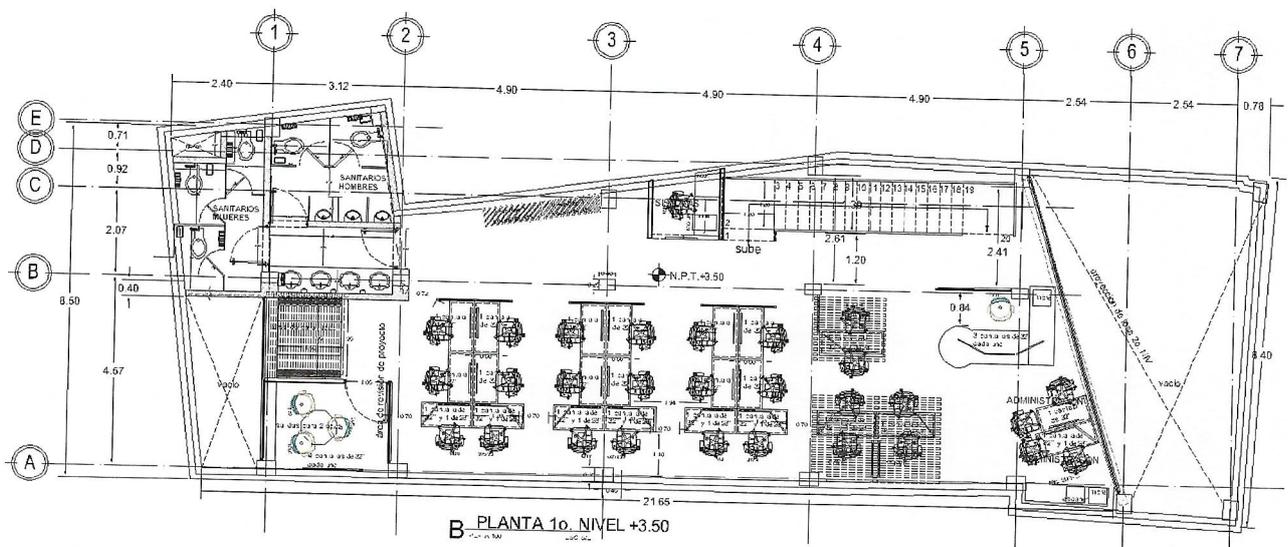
Planta de Arquitectónica Primer Nivel de proyecto de oficinas
